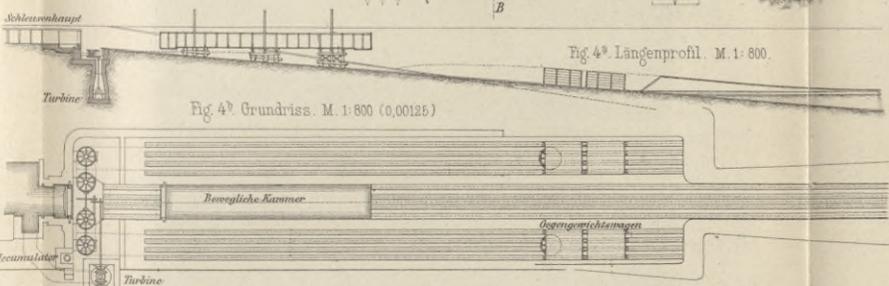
<sup>b</sup> Grundriss. M. 1:800 (0,00125)
